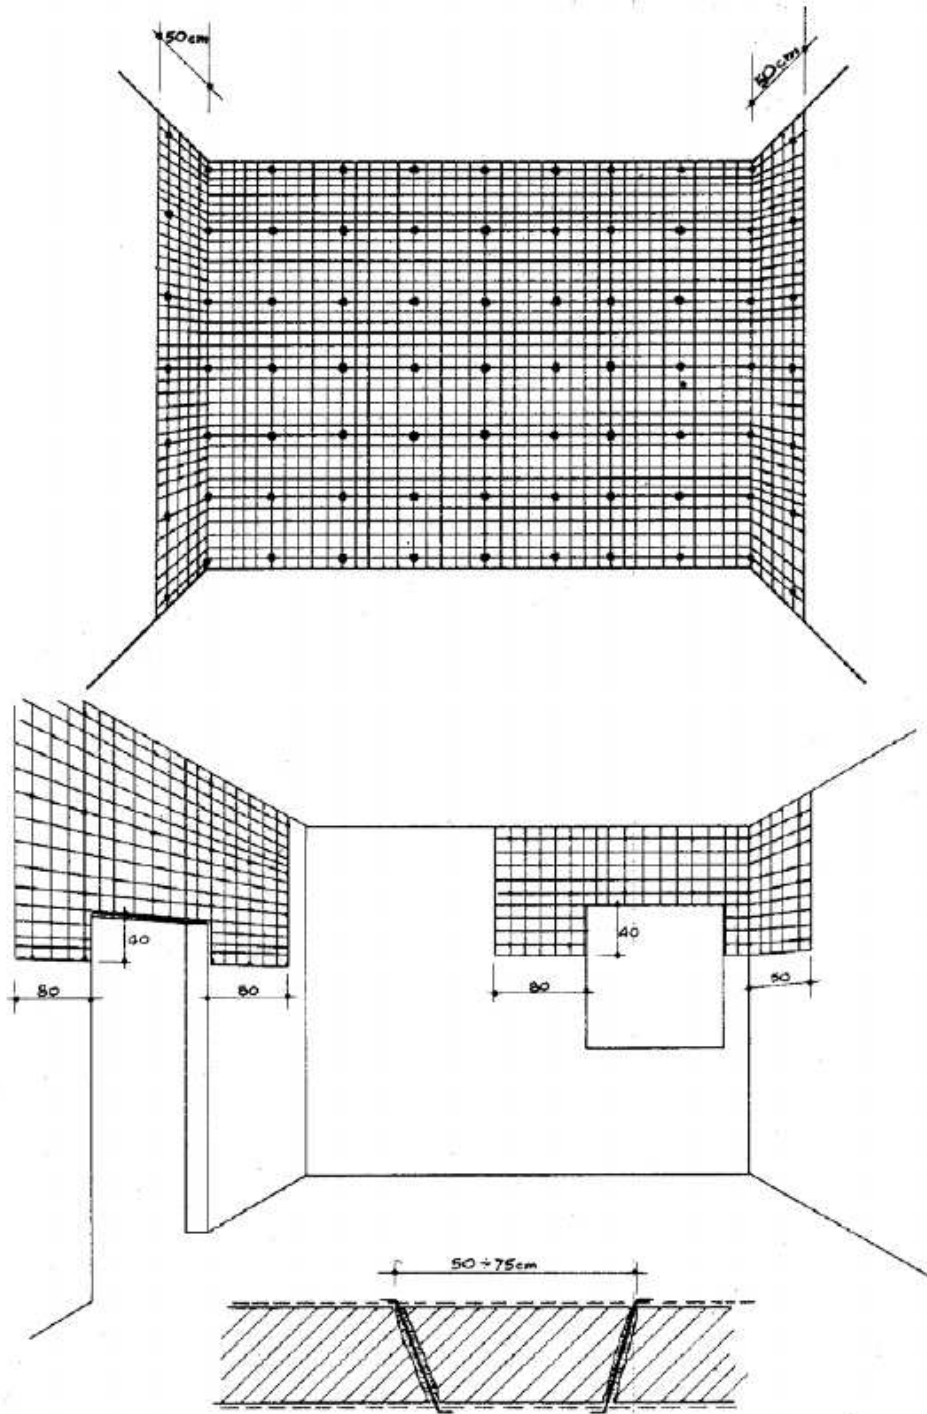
Posizionamento della rete metallica nel caso di consolidamento di un'intera parete e in corrispondenza di fori e aperture; particolare del collegamento tra le reti in sezione orizzontale
